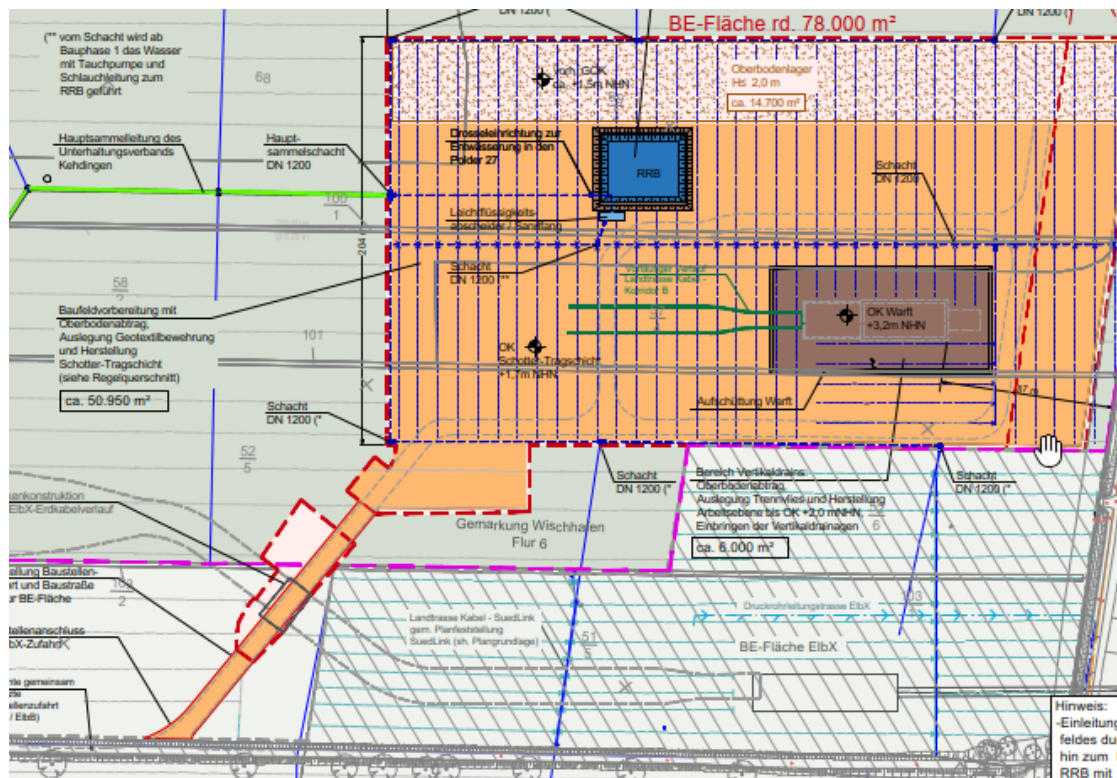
Planausschnitt mit Verortung der Brückenkonstruktion (KorB_ElB_F1.2.3.5_LP-BE-NI-Phasen)
